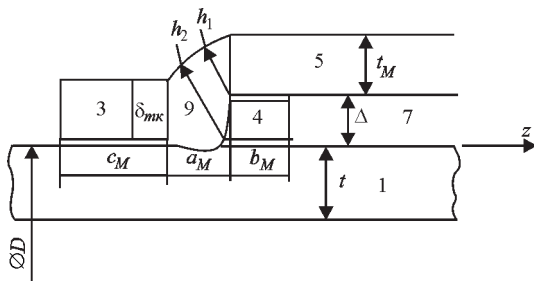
Схема перерізу кільцевого з'єднання монтажного вузла кріплення герметичної муфти з компаундним наповнювачем до трубопроводу
